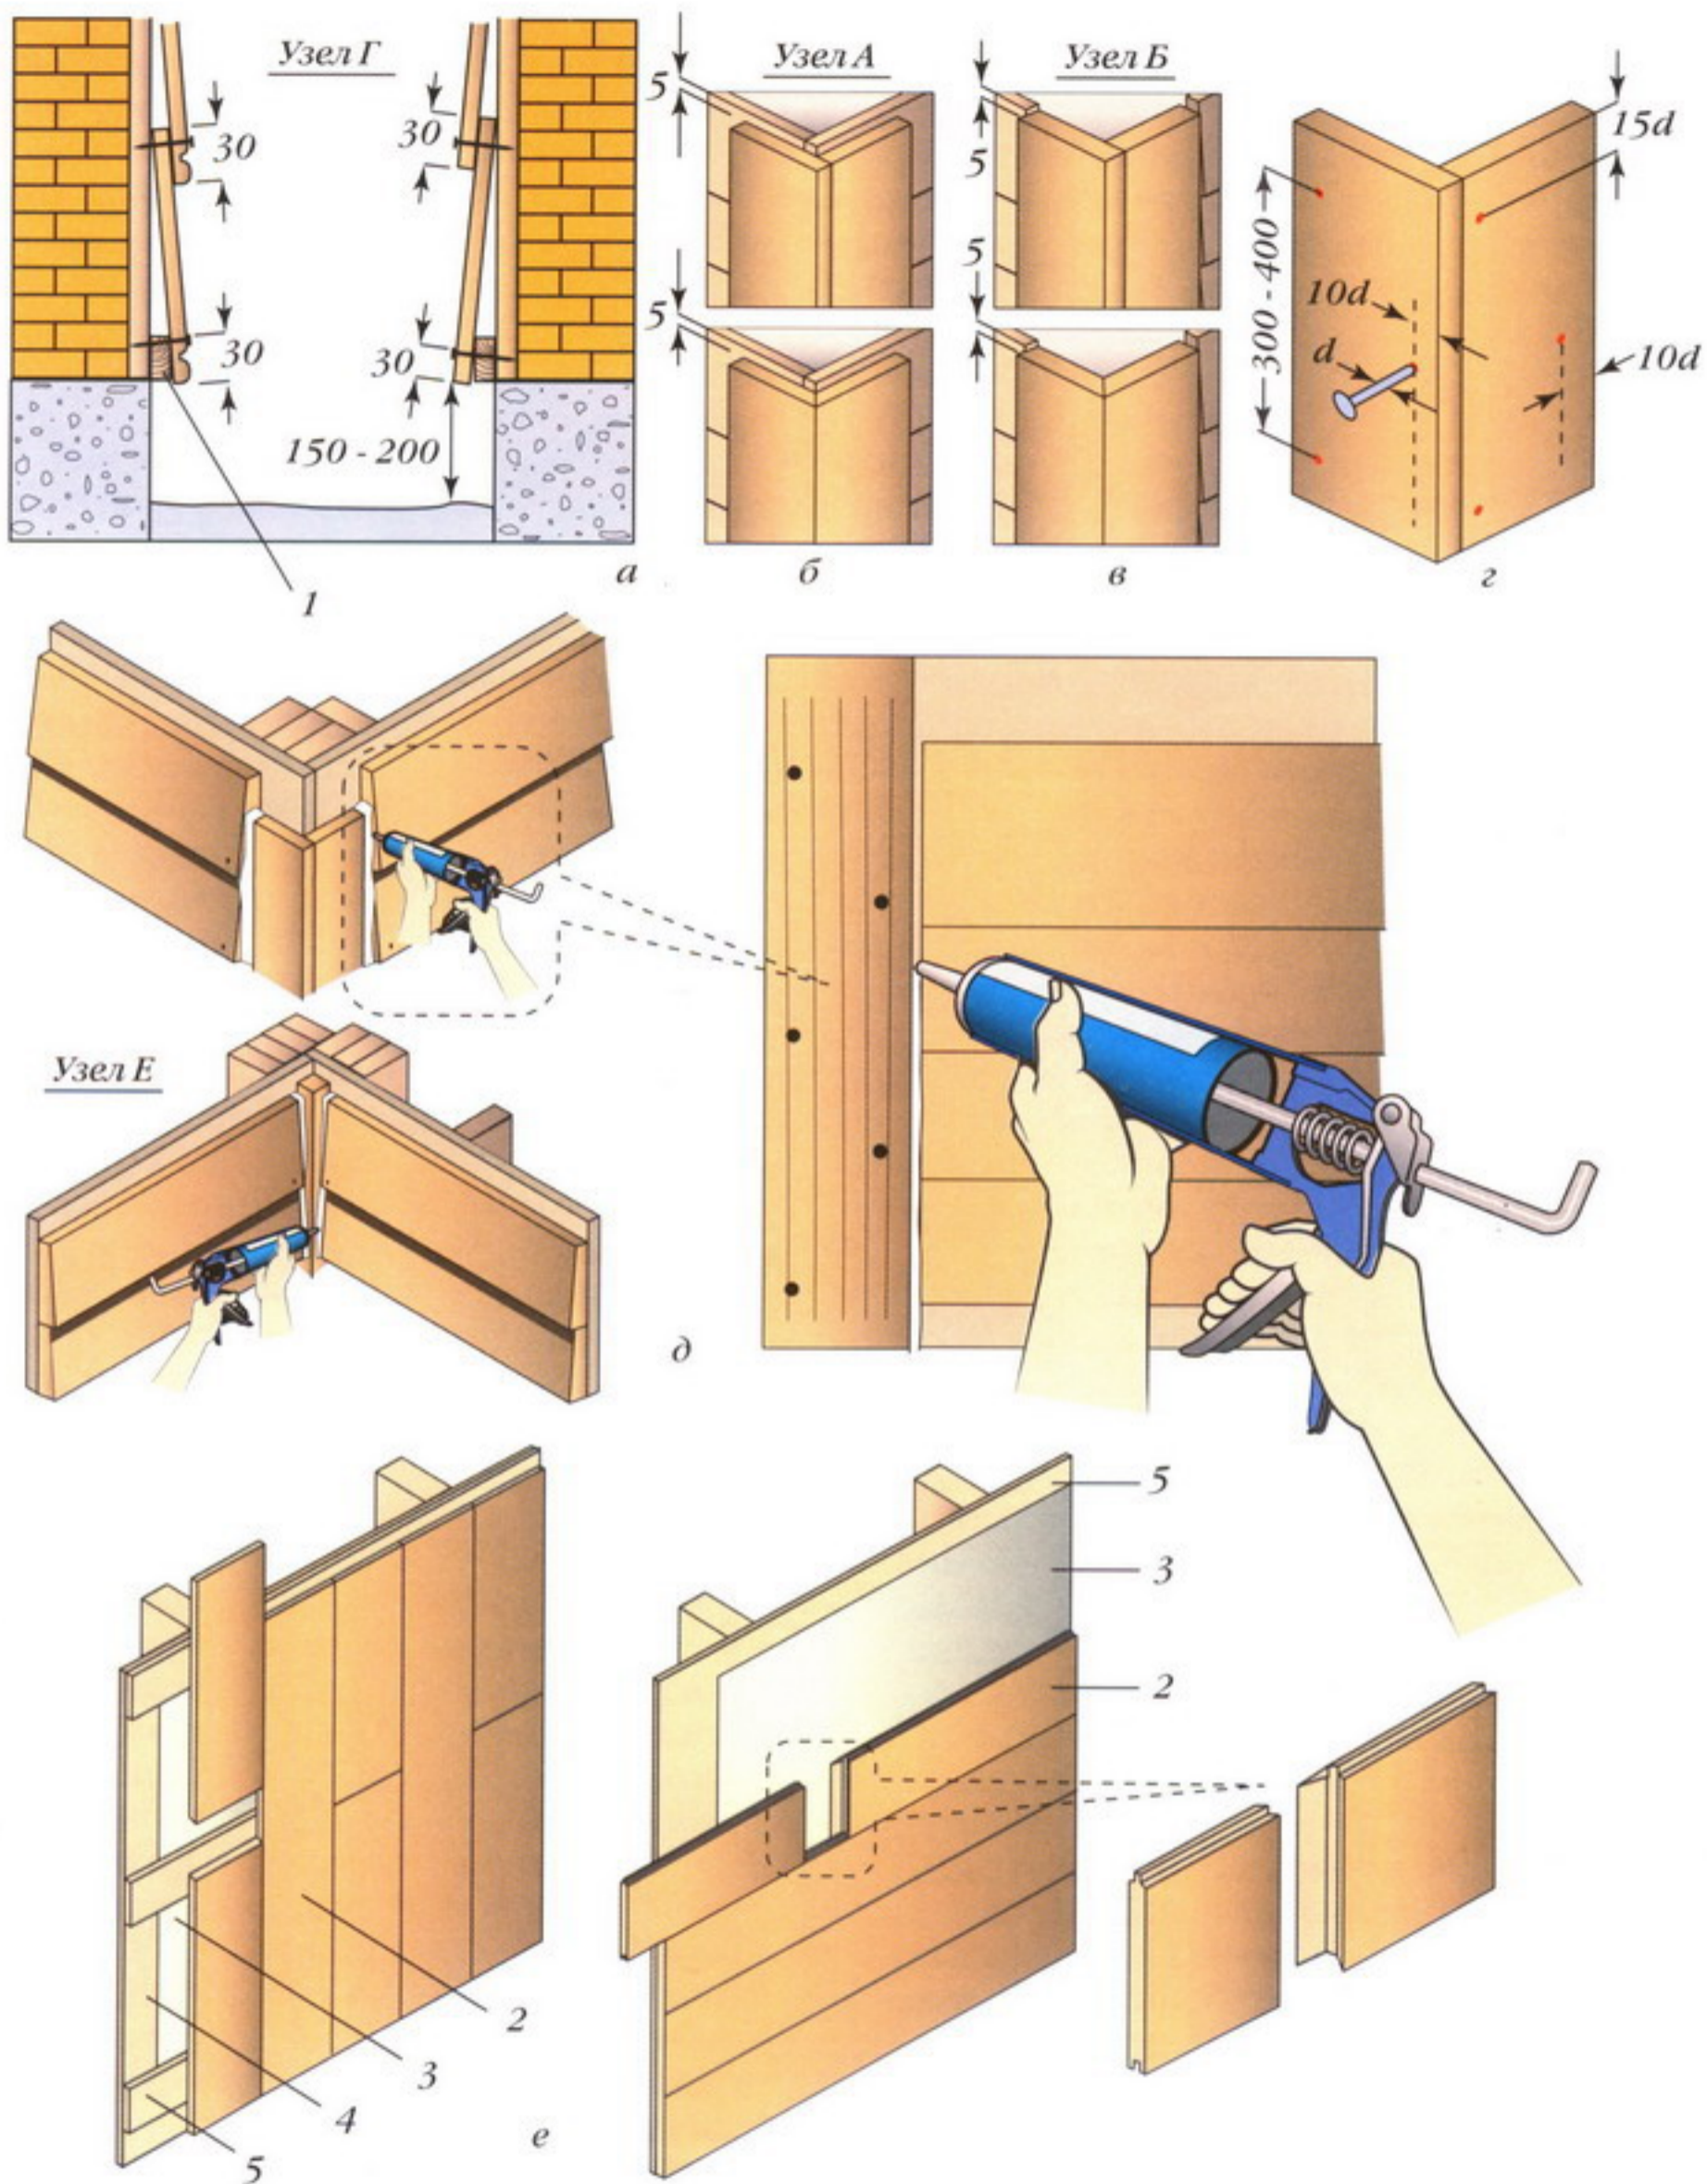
Монтаж погонажного сайдинга (узлы): а — расположение первой панели; б — углы «внакладку»; в — углы заподлицо; г — расположение гвоздей; д — гидроизоляция; е — стыкование панелей по длине; 1 — стартовый брусок; 2 — рядовой сайдинг; 3 — гидроизоляция; 4 — обрешетка; 5 — контробрешетка
